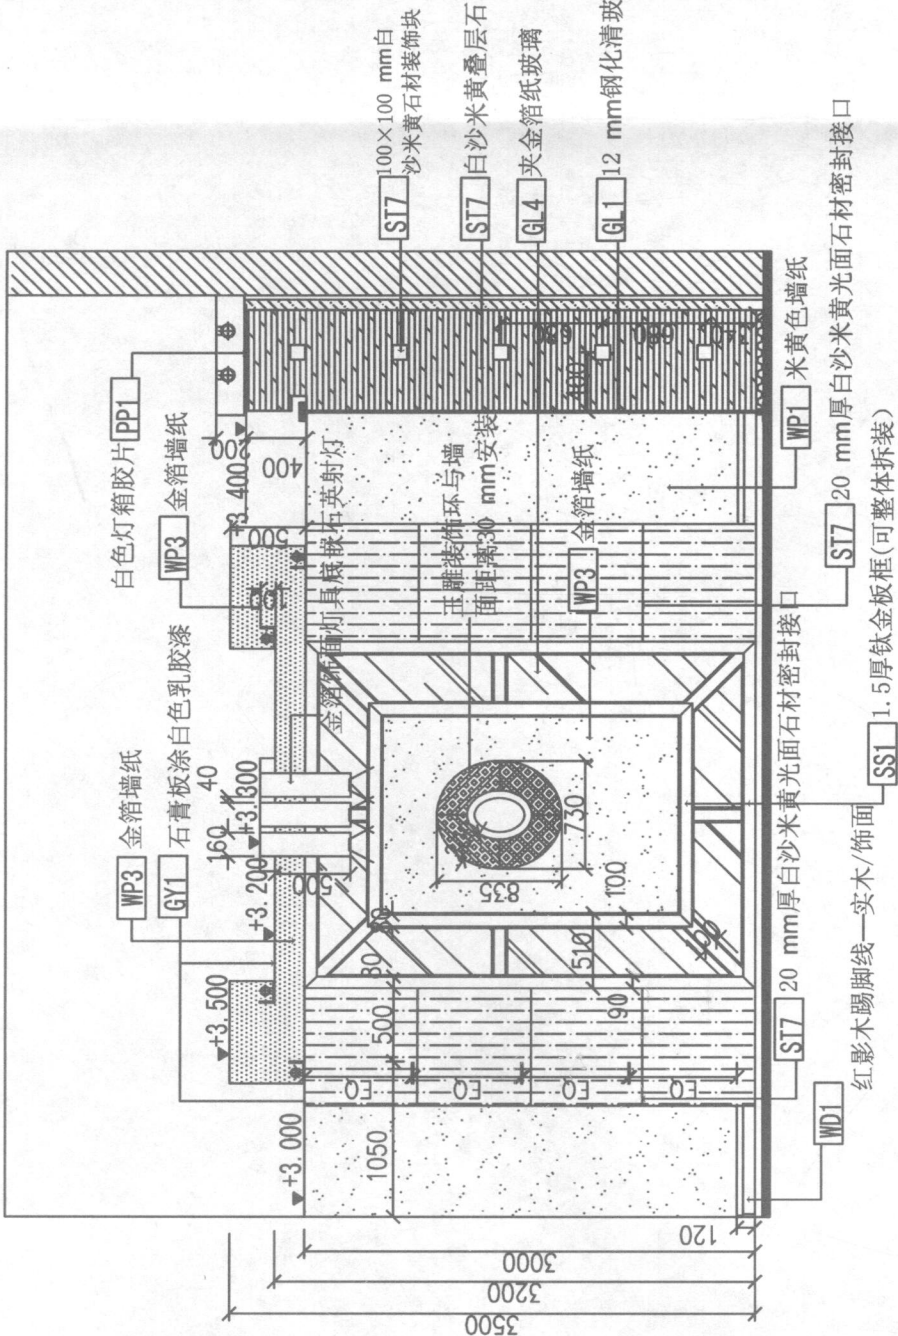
某装饰工程 B 型 VIP 包房立面图 (一)
